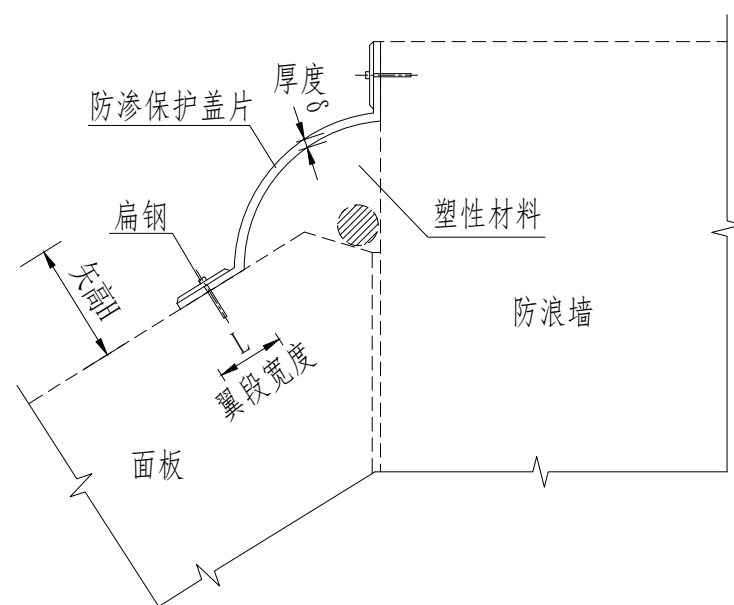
防浪墙水平缝（E型缝）防渗保护盖片剖面图
